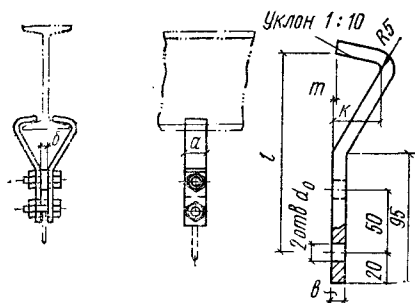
Хомуты для крепления полиэтиленовых труб  $D_y$  100 мм к закладным деталям сваркой в санитарно-технических кабинках
